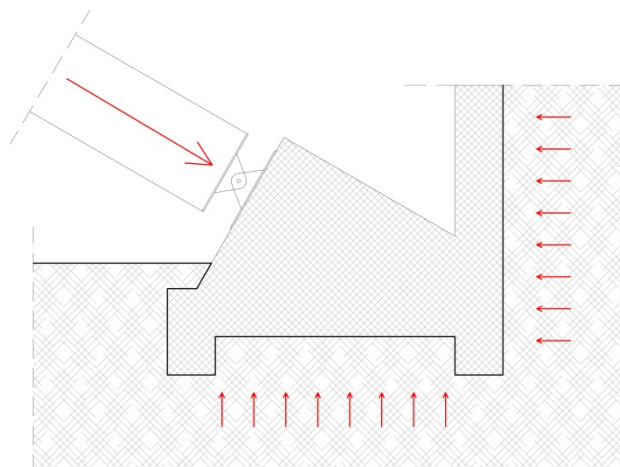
SCHEMA PLINTO DI FONDAZIONE
